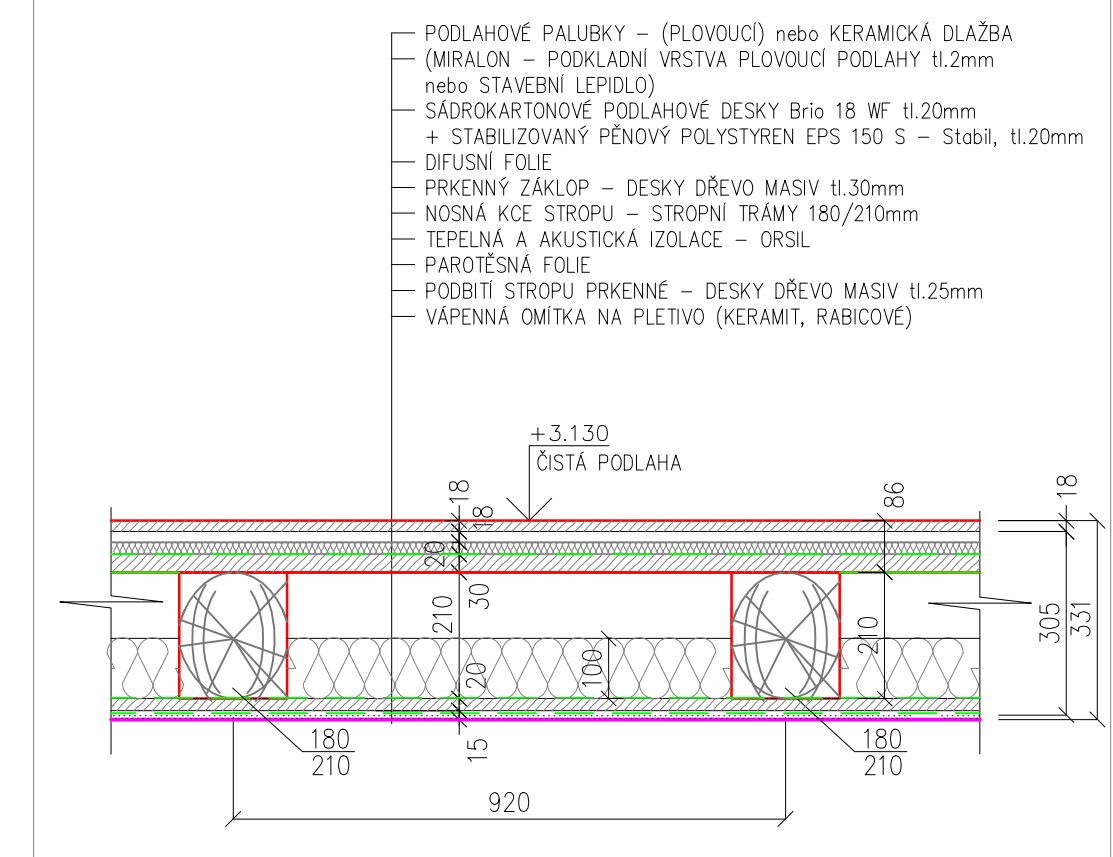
DETAIL SKLADBY STROPNÍ KONSTRUKCE
